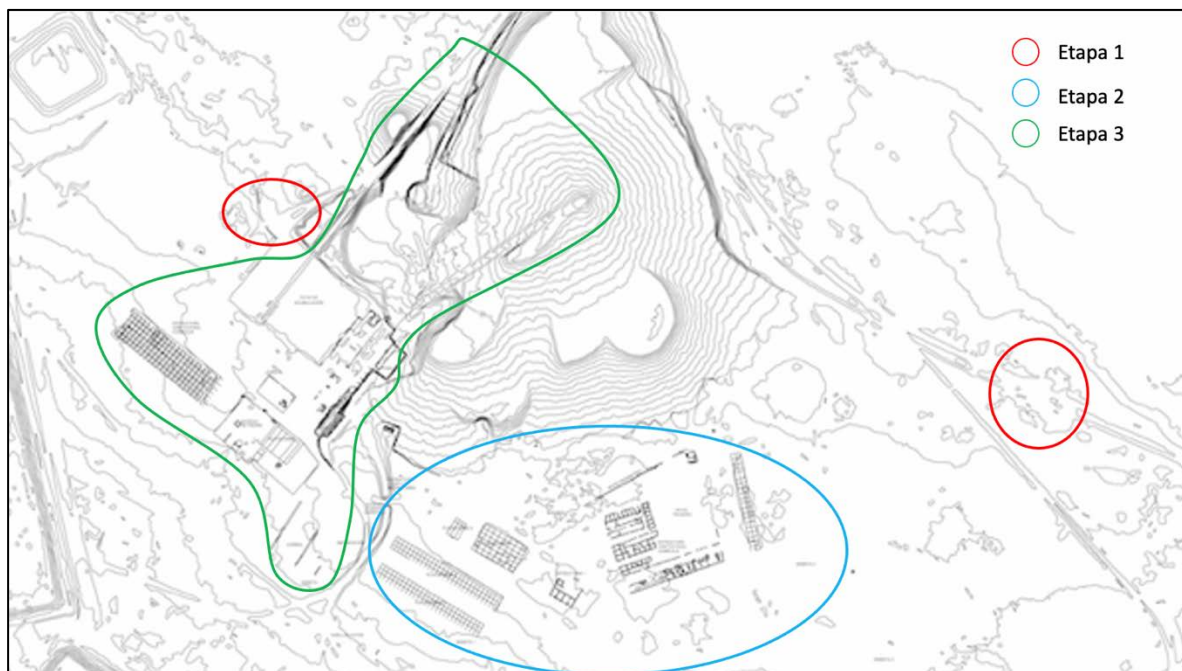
Planta con estructuras zonificadas por etapas de producción.
